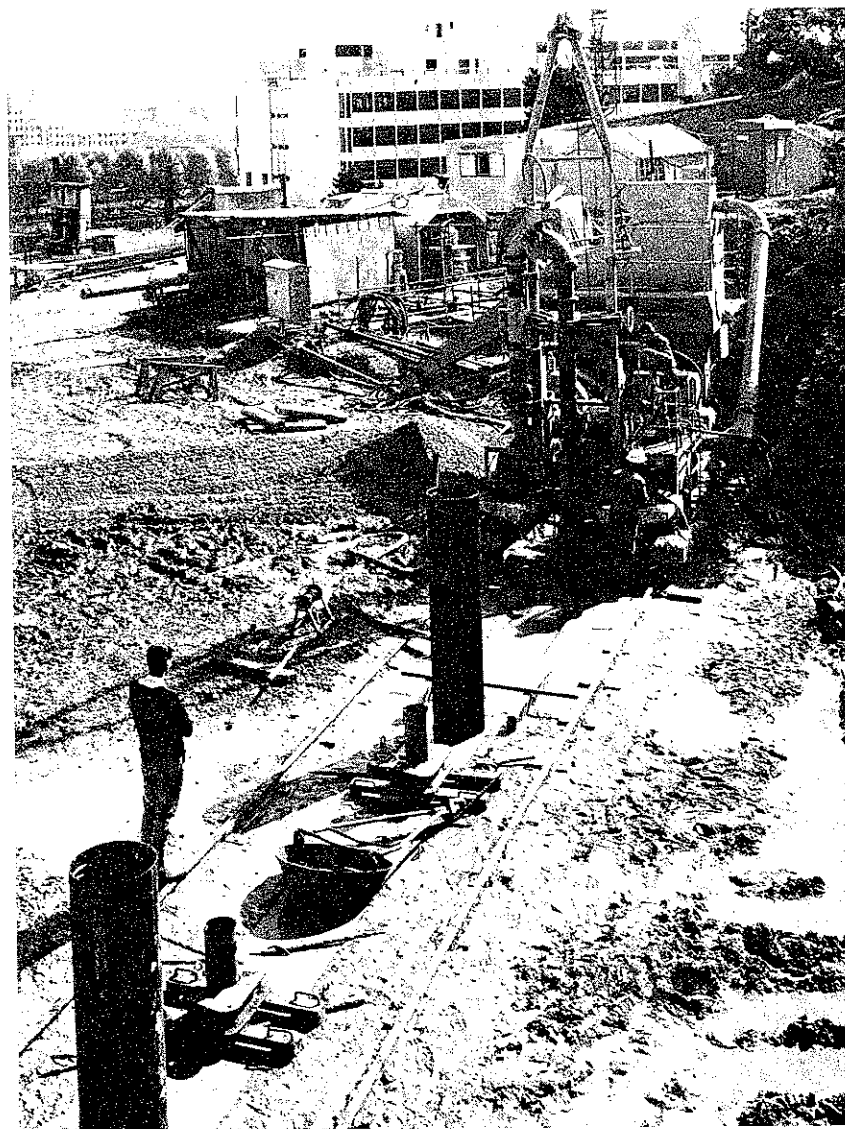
Paroi moulée du tunnel de Fourvière. On distingue les tubes métalliques verticaux qui servent de coffrage à la jonction des différents panneaux. Photographie : Studio Villeurbannais.
